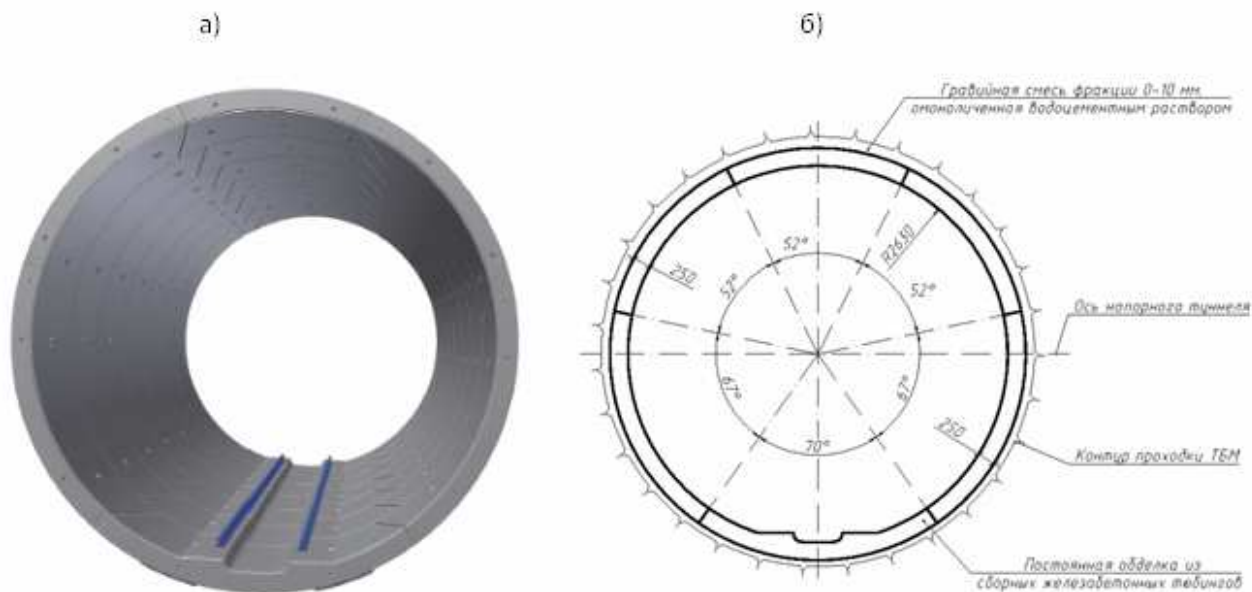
Конструкция сборной железобетонной обделки напорного туннеля ГЭС Мтквари в Грузии
